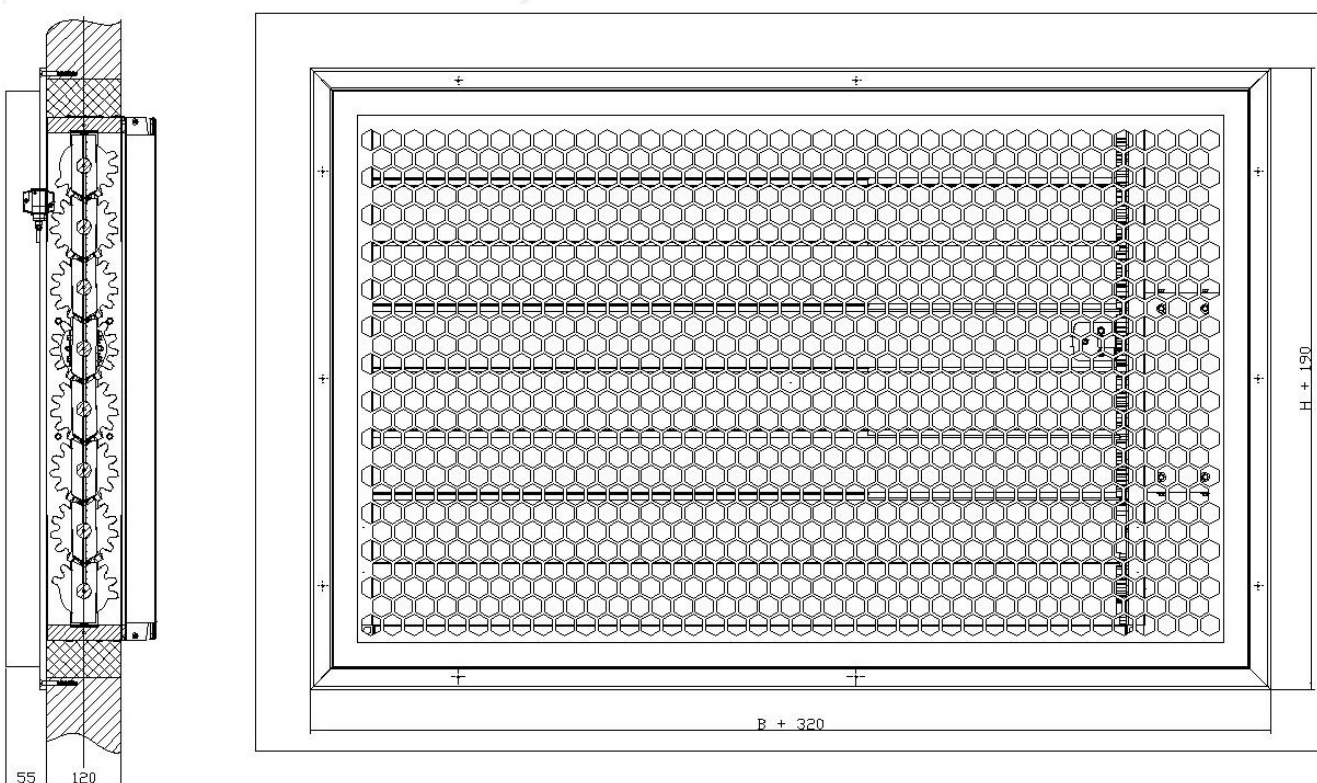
Sposób montażu klap WKP-P w podatnych konstrukcjach ściennych
